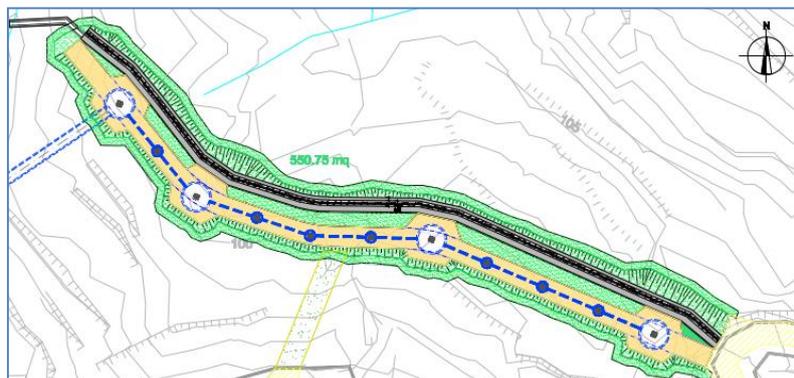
Inerbimento area lavorazione "pozzi drenanti"-pianta
